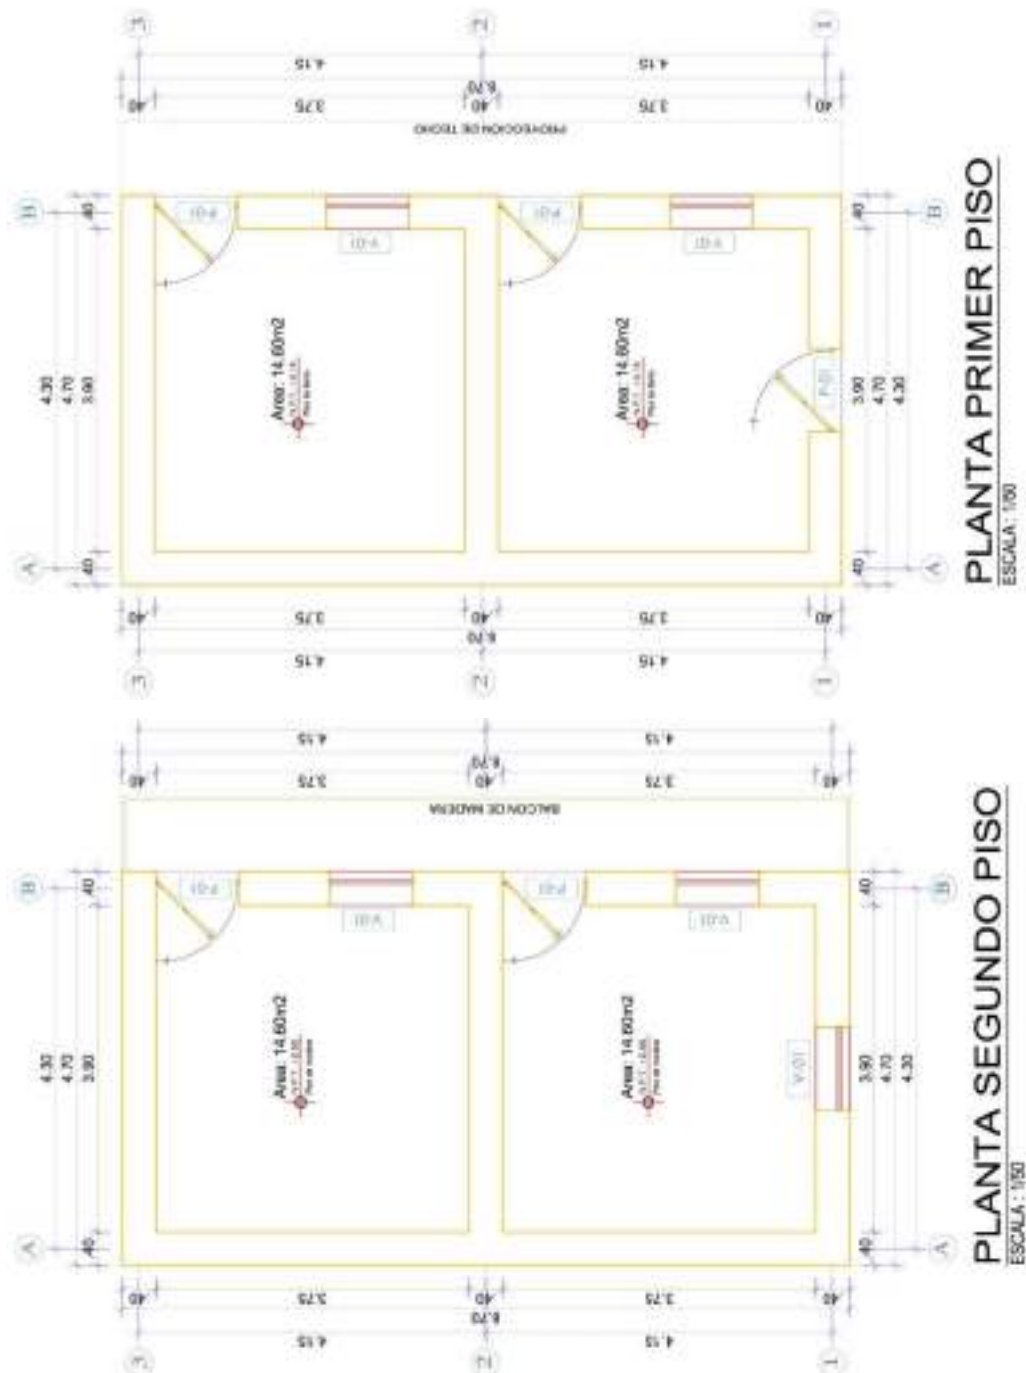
Vista en planta de viviendas en forma rectangular promedio.
